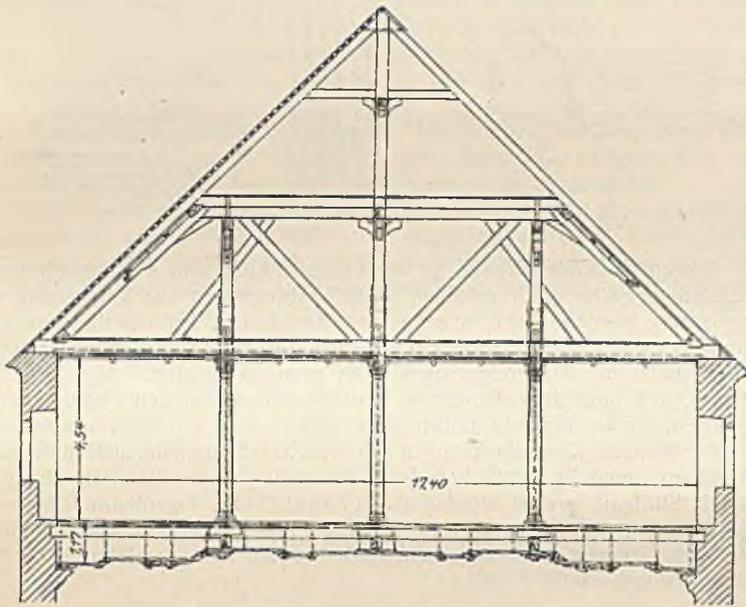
Decke und Dachstuhl über dem „Goldenen Saal“ des Augsburger Rathauses.
